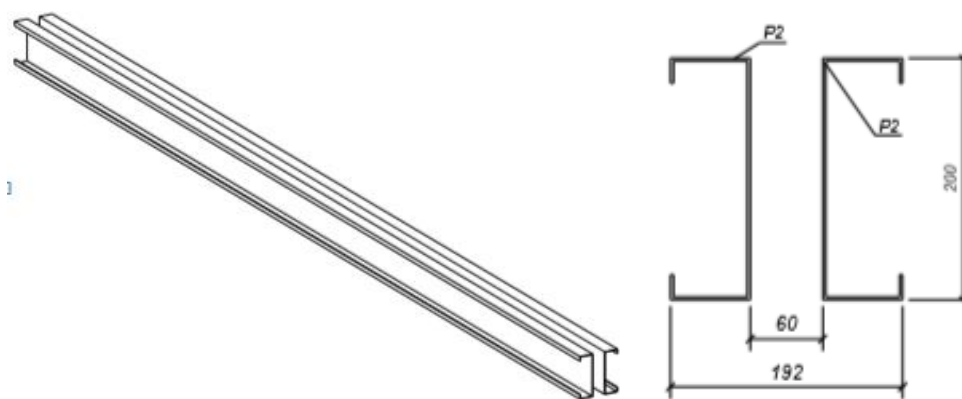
Vedere 3D si in sectiune a grinzilor si stalpilor structurii de rezistenta (elemente ușoare formate la rece)
